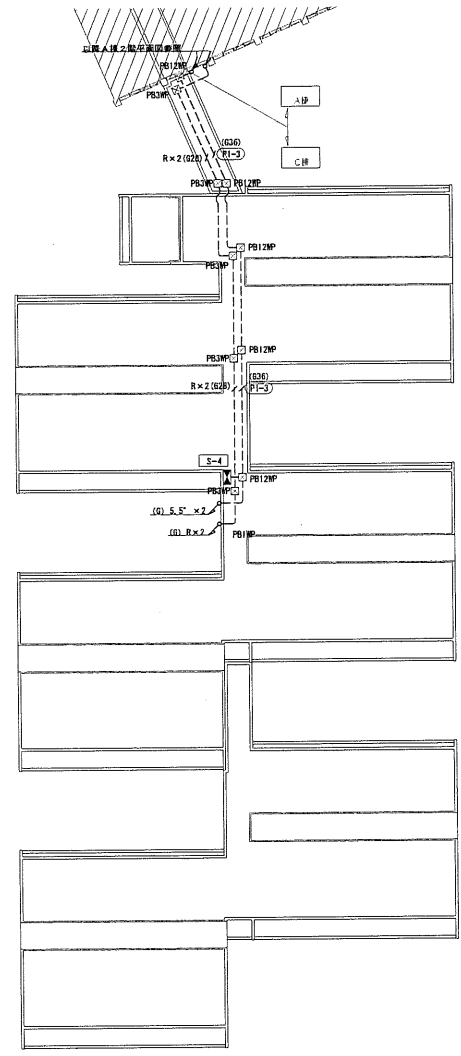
階平面図 (電源・制御)		学校名	古江台小学校
